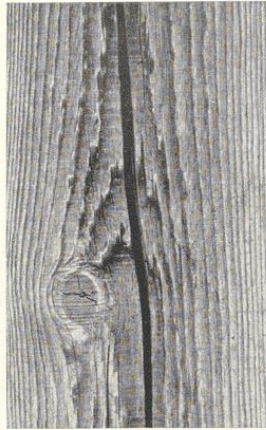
Ausgetrockneter, gerissener Holzpfosten einer Fachwerks-
